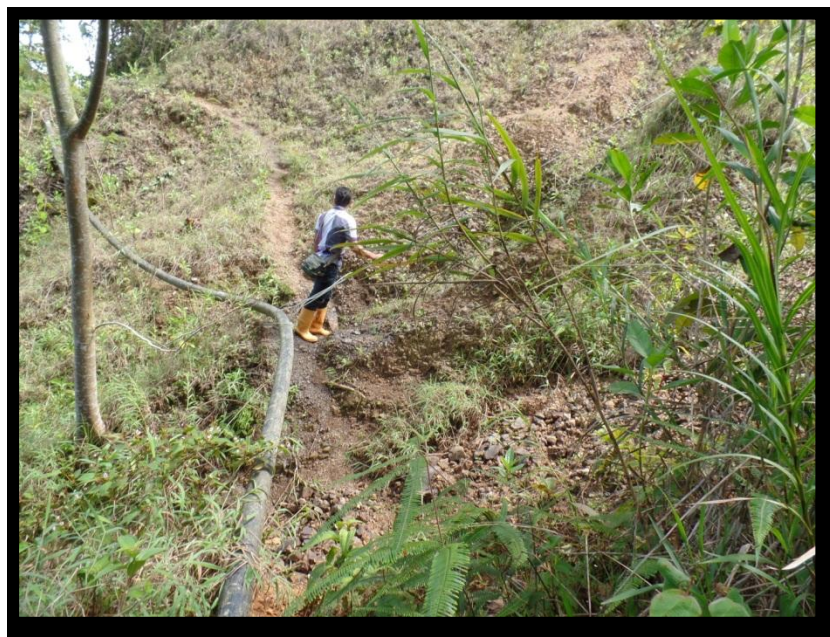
Tramo de Tubería deflectada por falta de apoyo.
